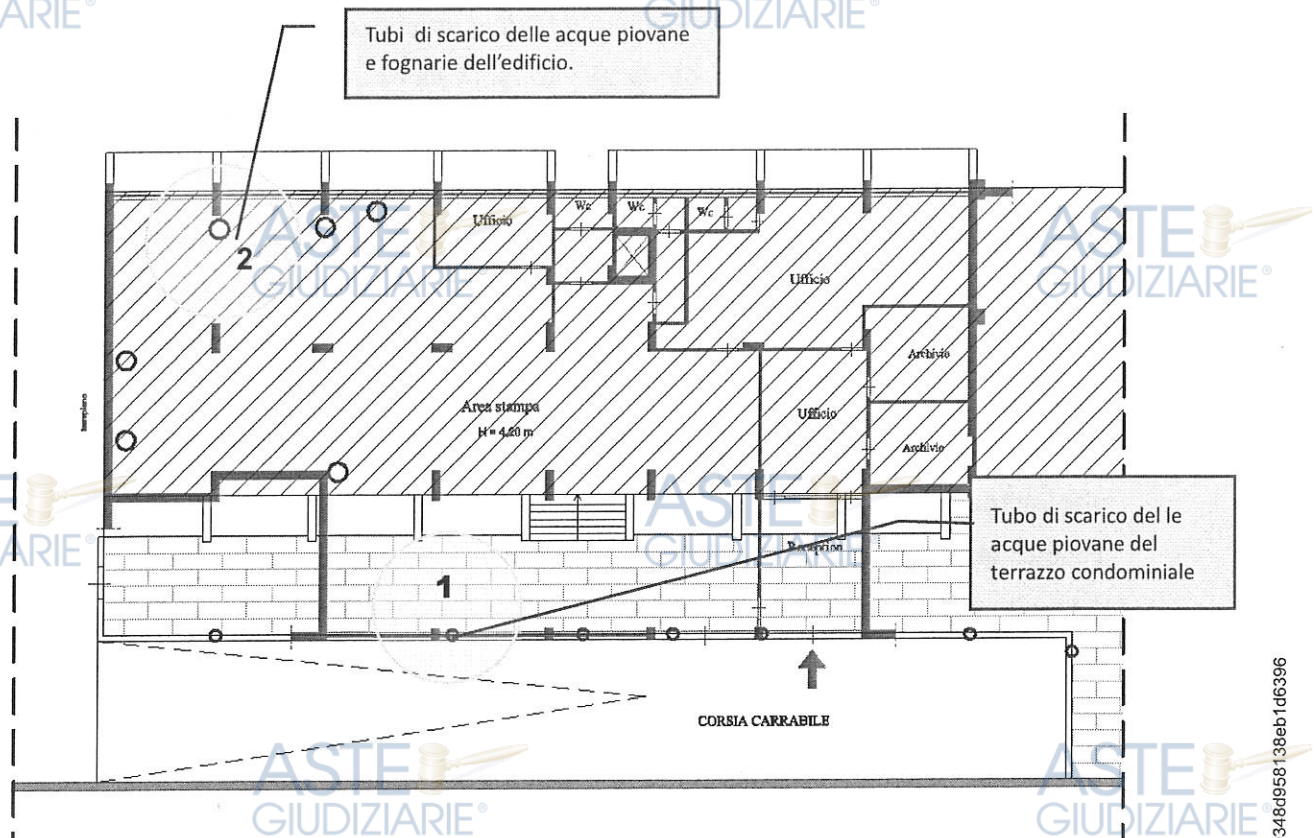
Sovrapposizione planimetrica del terrazzo condominiale d'ingresso allo stabile con il lotto 3.
